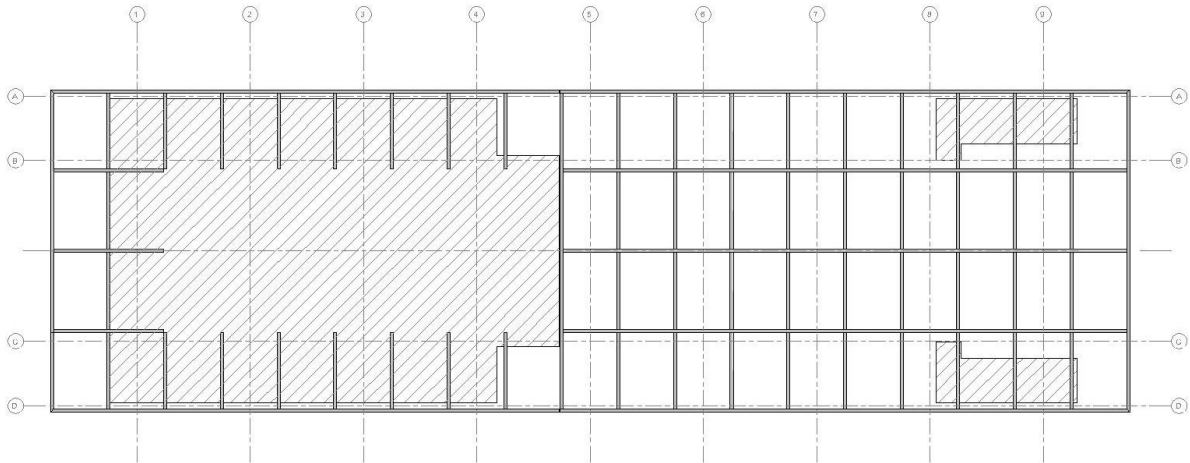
Pianta copertura – Struttura in carpenteria metallica e c.a. - Tipologica
